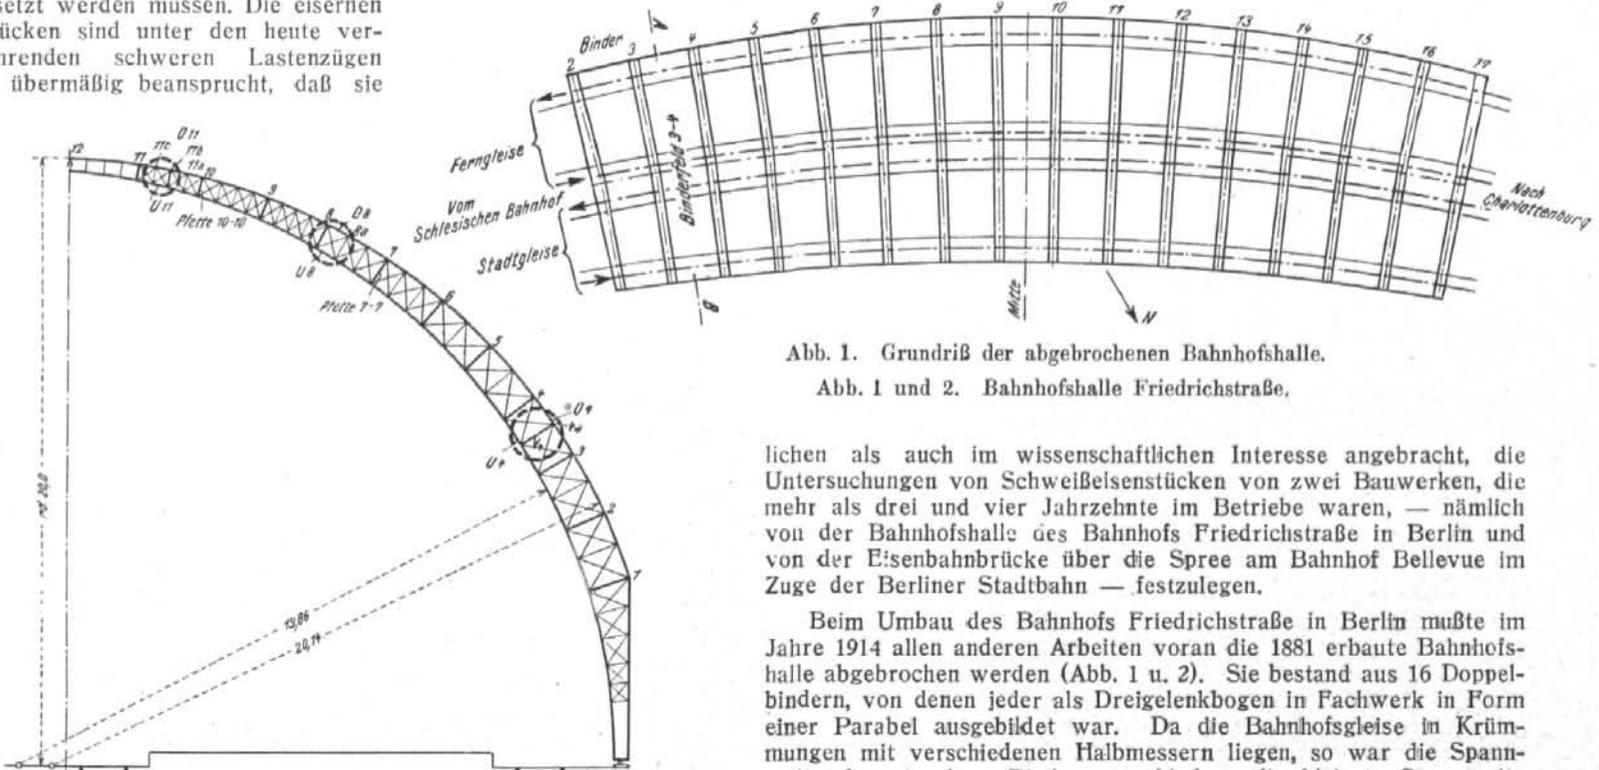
Grundriß der abgebrochenen Bahnhofshalle.
